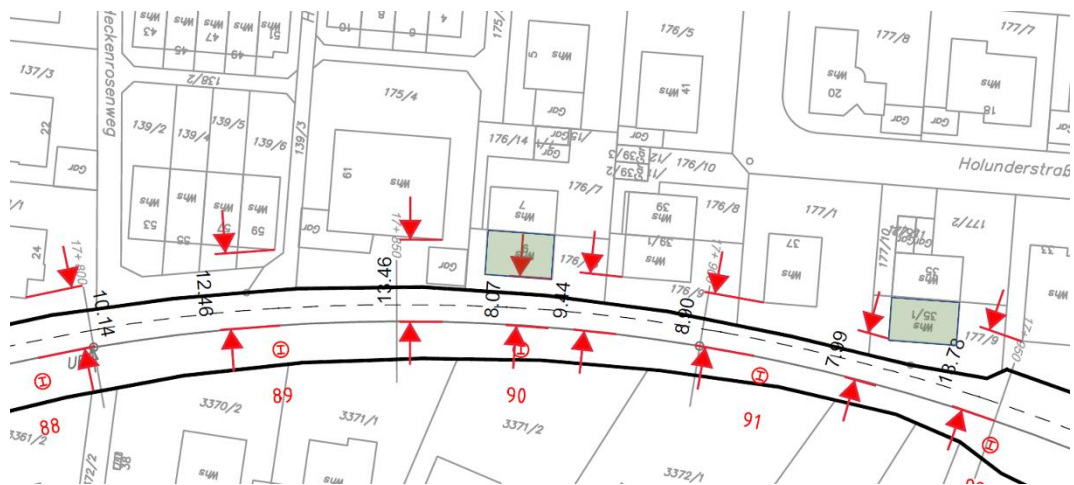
Ausschnitt aus dem Lageplan „Gültstein“ [15]
